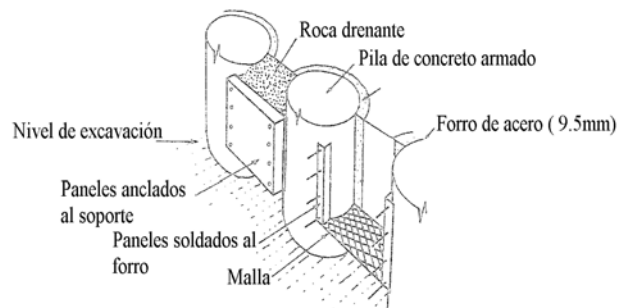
Detalle constructivo en cara de muro de pilotes (Hovland & Willoughby, 1982).
